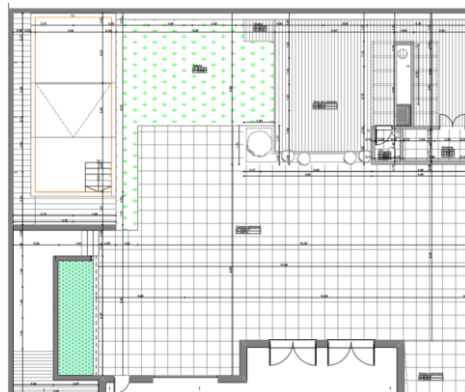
Planta Proposta Remodelação jardim. Fonte: Biblioteca atelier
